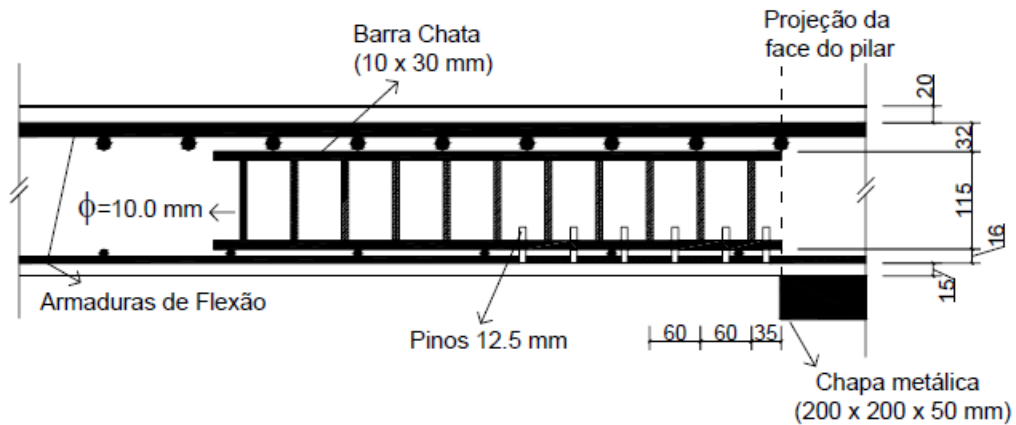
Detalhe das armaduras de cisalhamento da pesquisa de Trautwein (2006)
